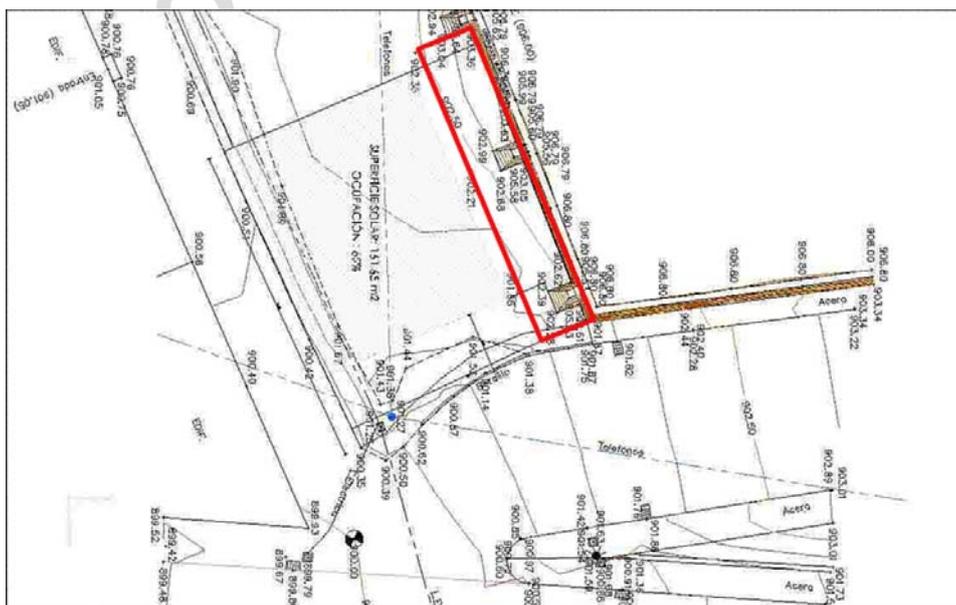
Planta del solar, señalado en rojo la zona donde se han realizado los bataches
